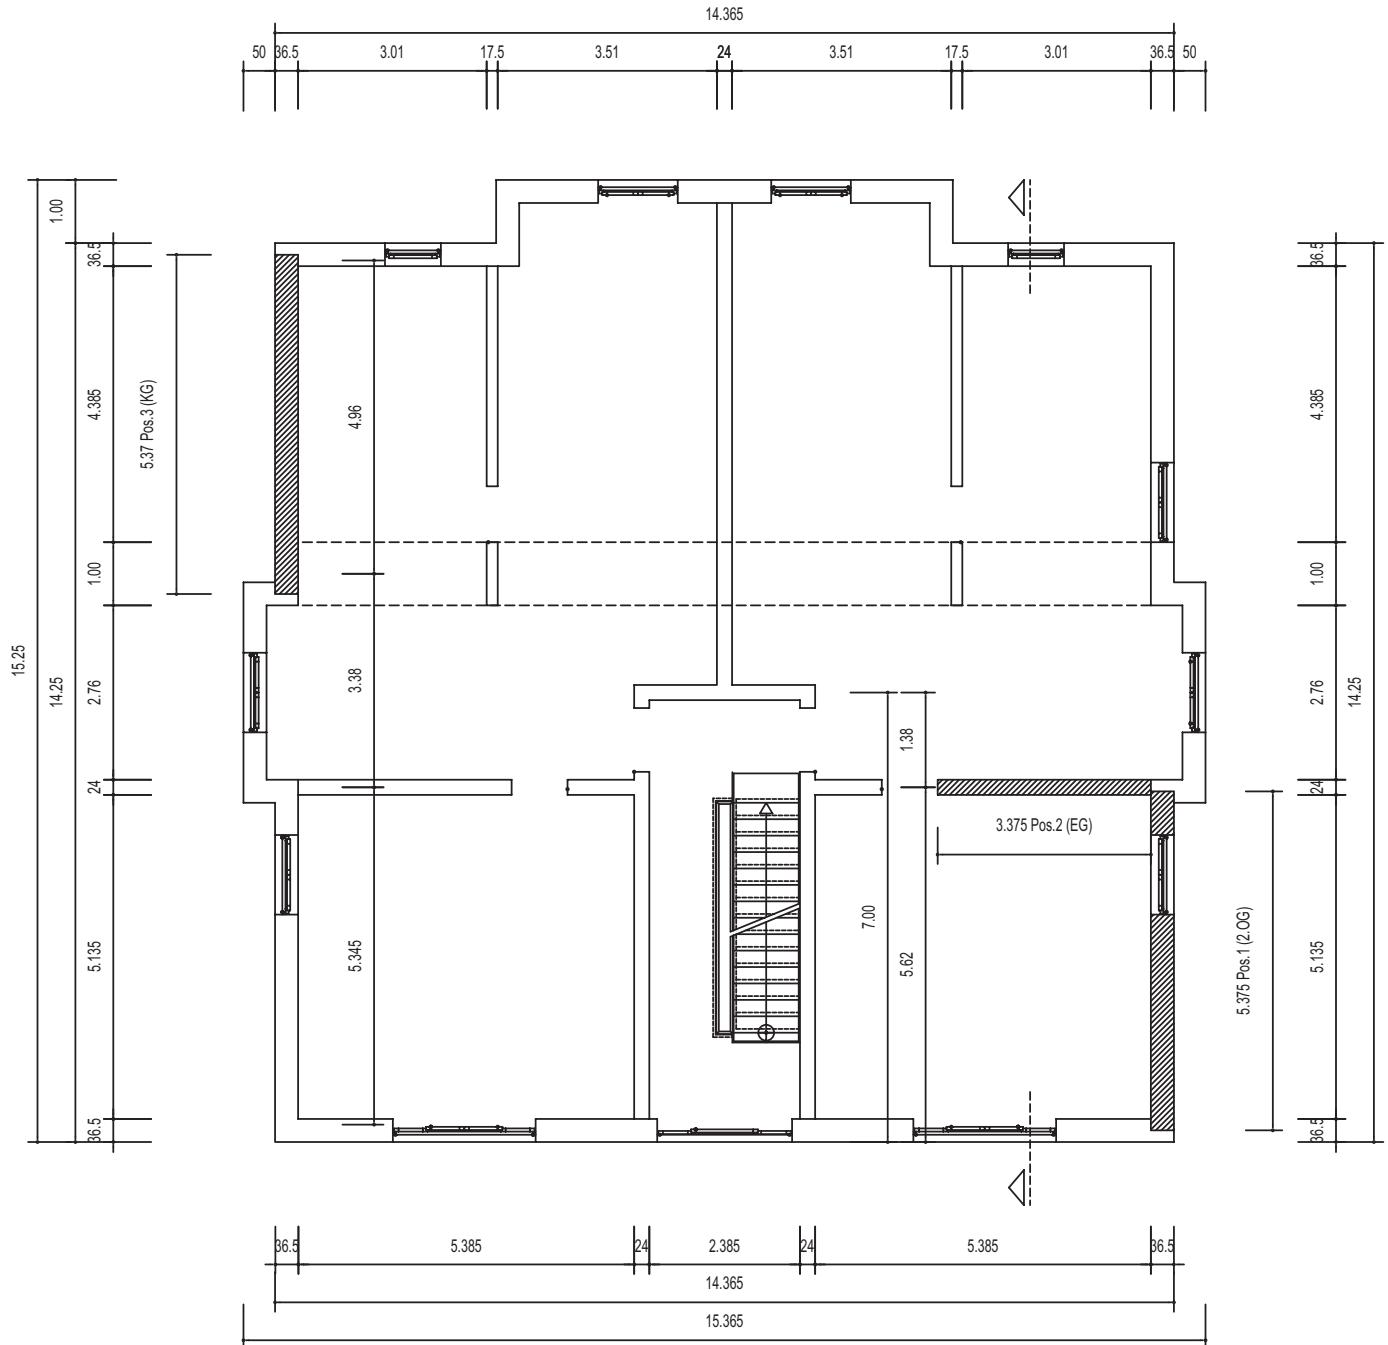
Grundriss des Mehrfamilienhauses
